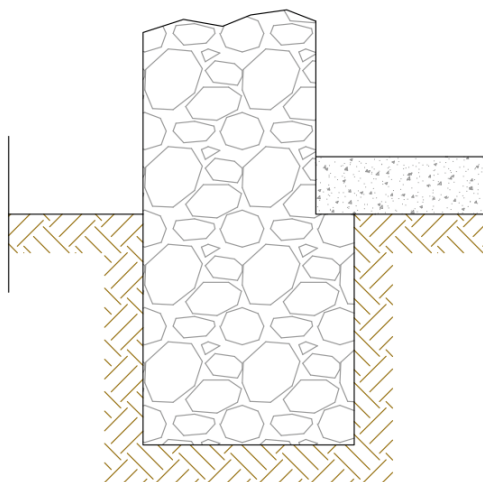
Muro de cimentación medianero existente en la vivienda objeto del TFG. Fuente propia.
